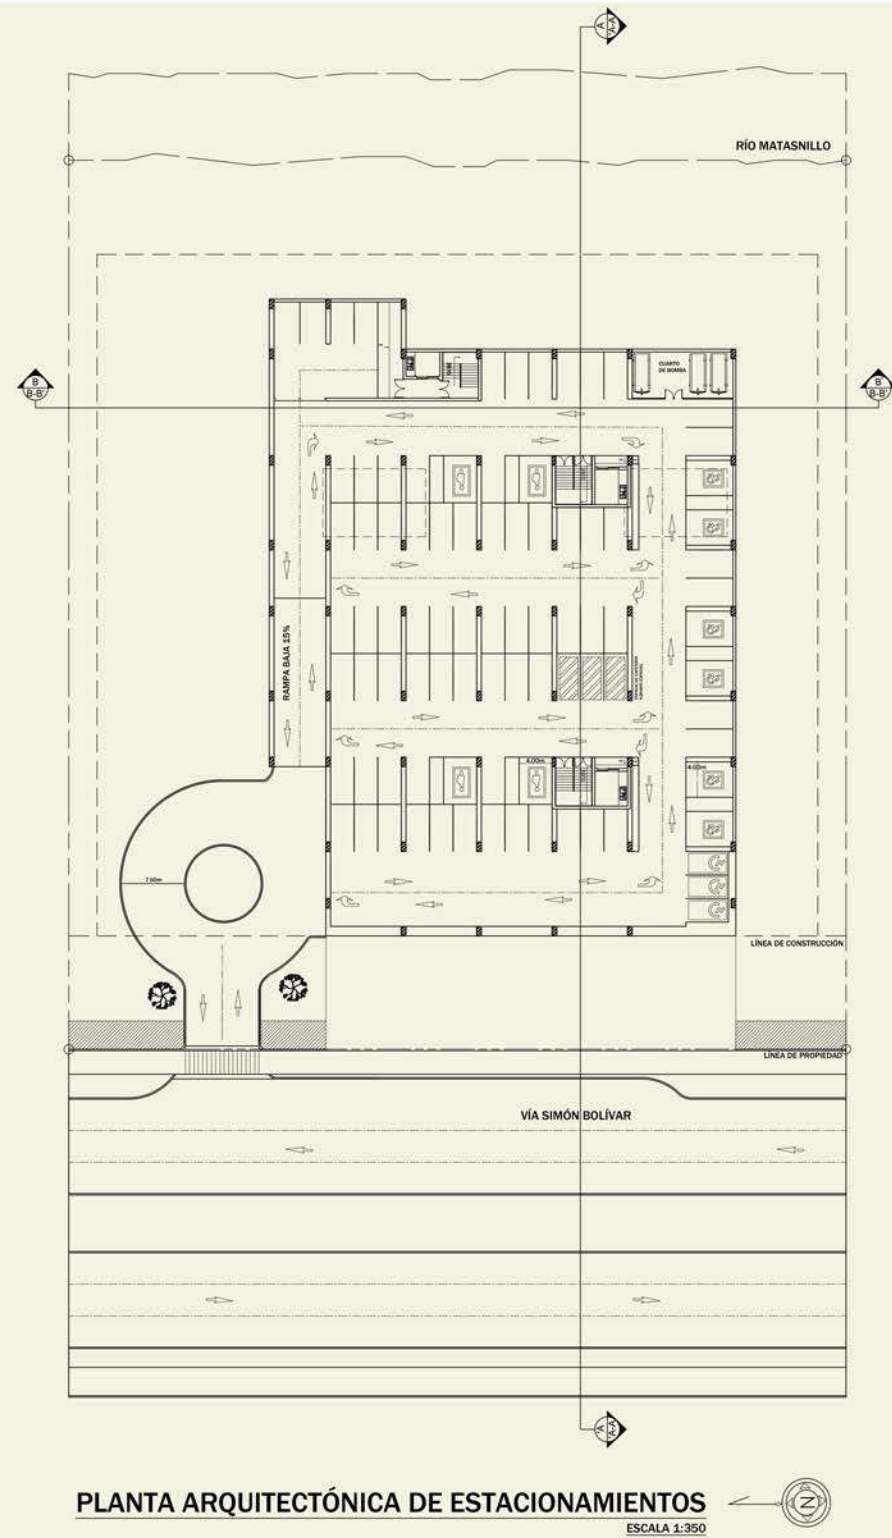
Planta arquitectónica de los estacionamientos. (Escala para plano 2x3)
